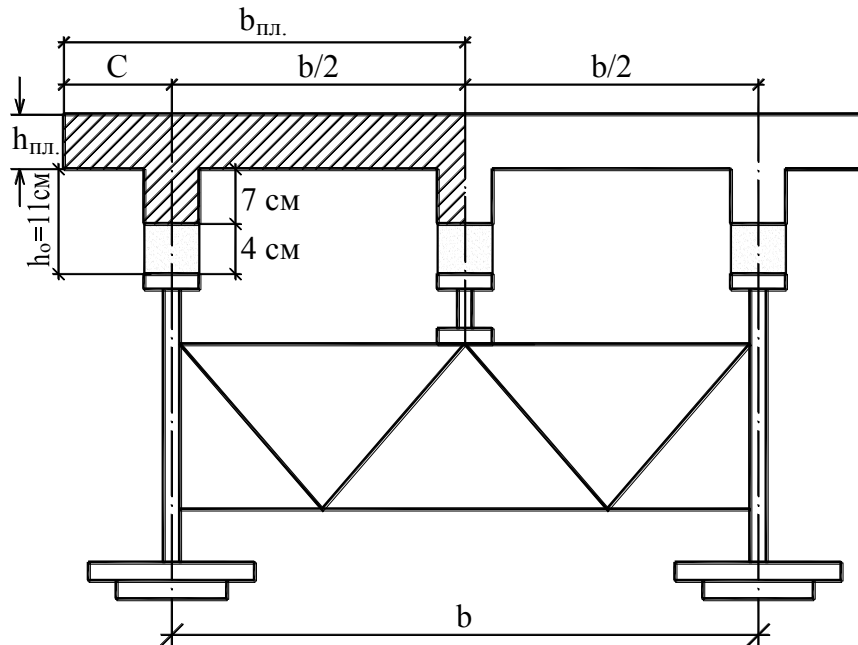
Схематический поперечный разрез сталежелезобетонного пролетного строения для габаритов Г-6,5; Г-8 и Г-10 м
